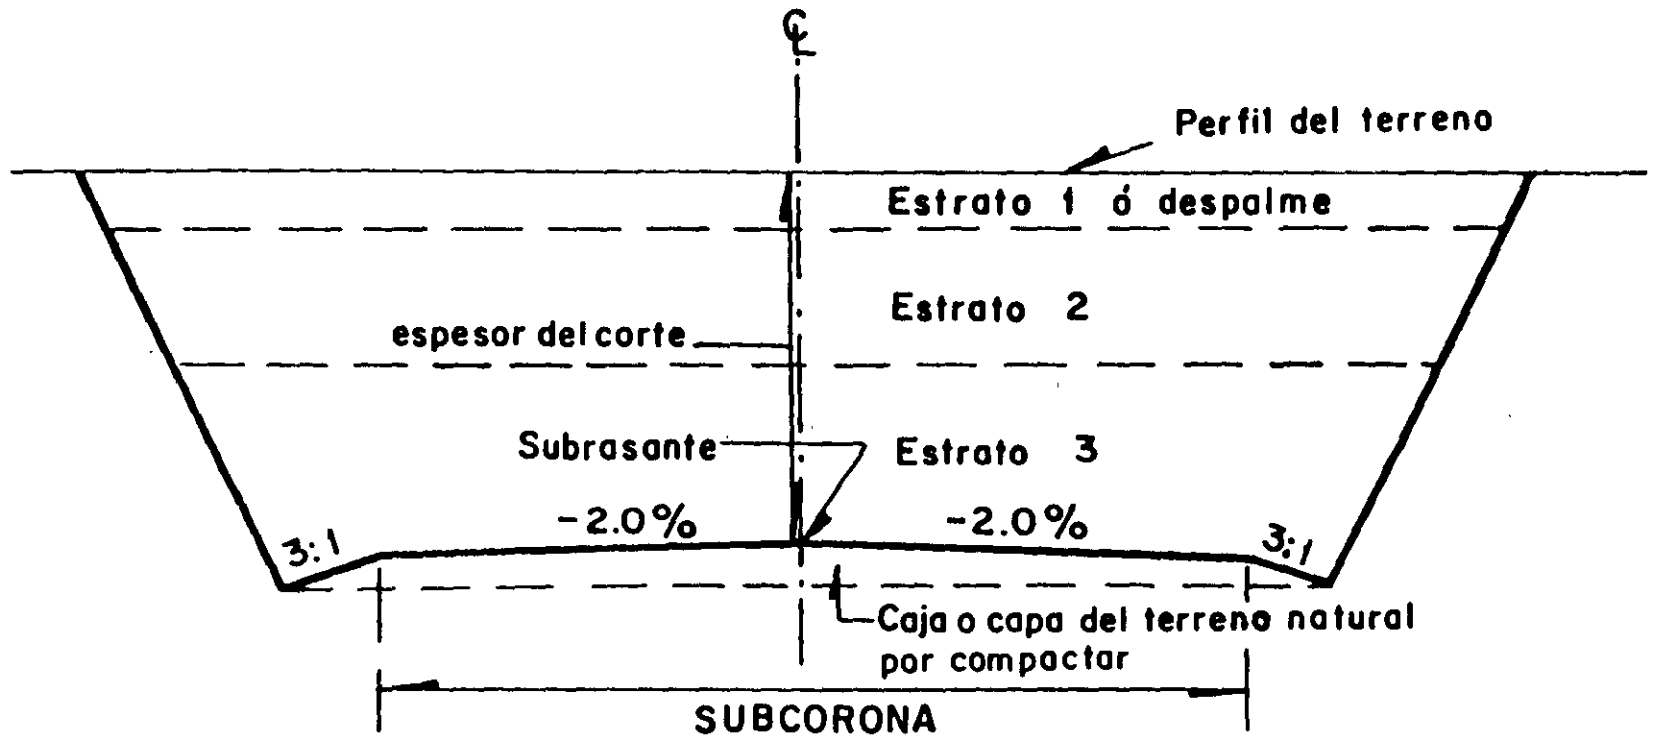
SECCION DE CONSTRUCCION DE UN CORTE EN TANGENTE
